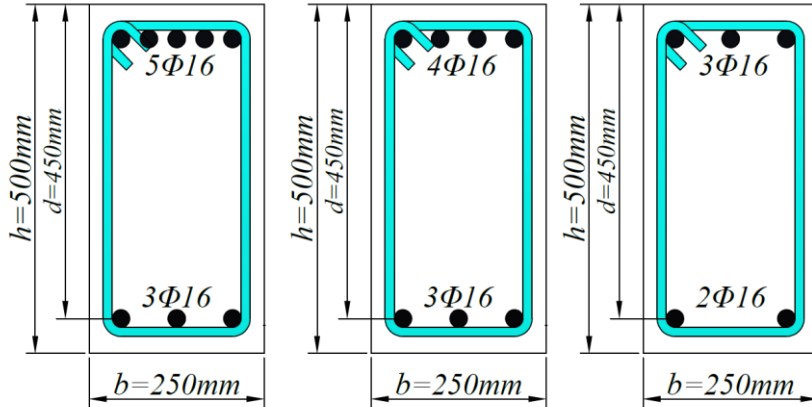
Betonarme taşıyıcı sistemlerinin kolonların en-kesit boyutları ve donatı yerleşim planı
